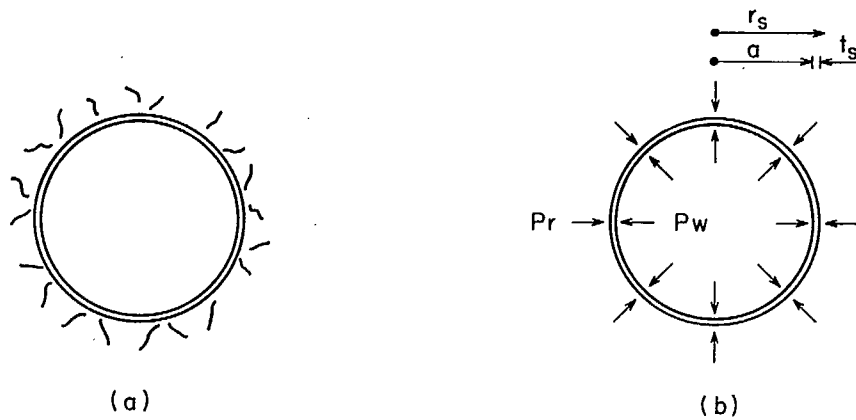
Le revêtement d'un tunnel à haute pression.
